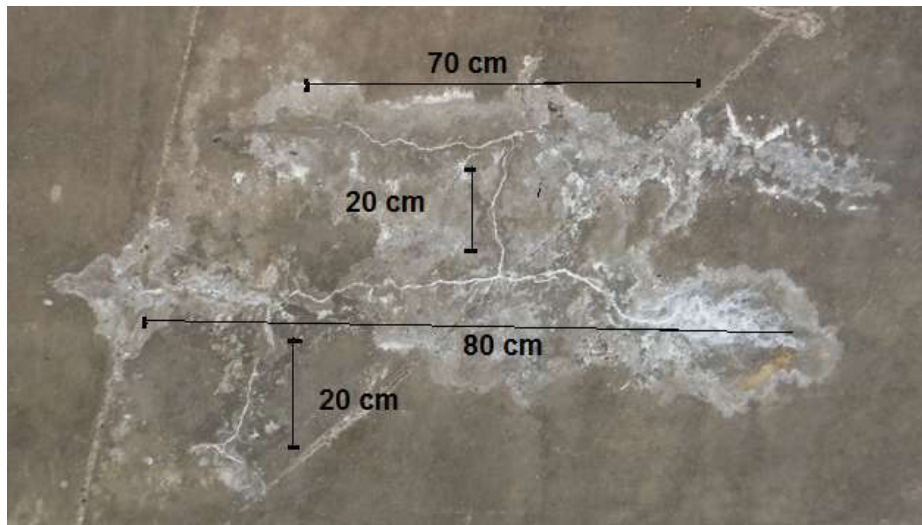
Medición de fisuras y manchas de lixiviación.
